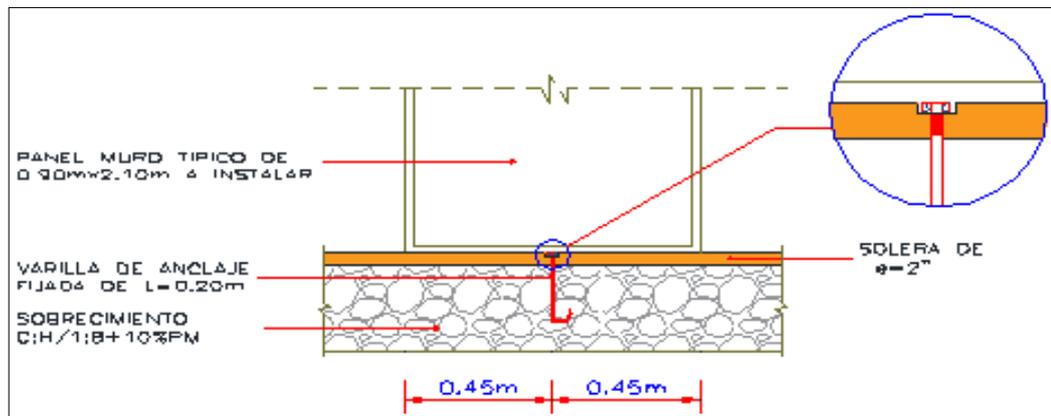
Distribución de varillas de anclaje de las vigas soleras inferiores al sobrecimiento
